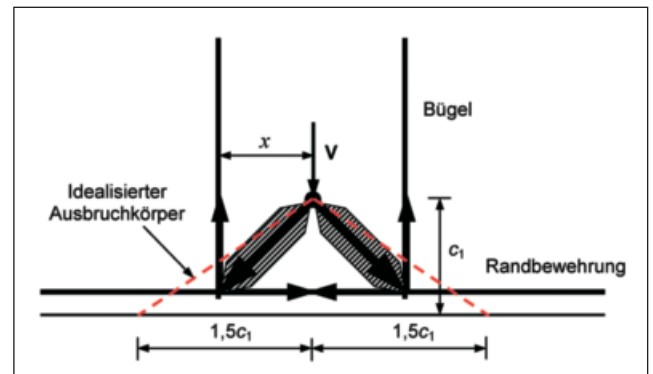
Fachwerkmodell für einen querbelasteten Einzelbolzen am Bauteilrand mit Rückhängebewehrung
